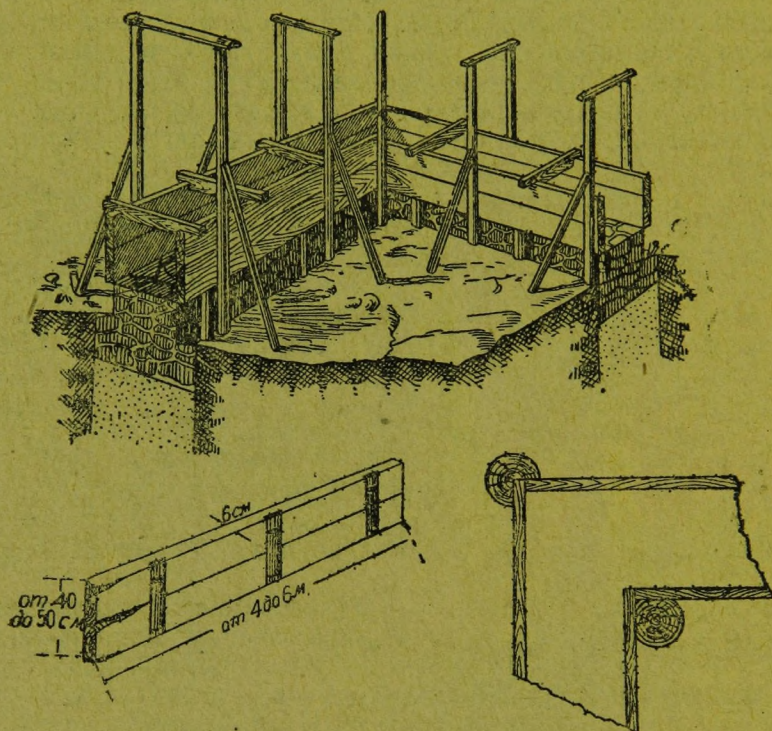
Устройство и установка щитов опалубки и стоек для набивки известково-песчаных стен
